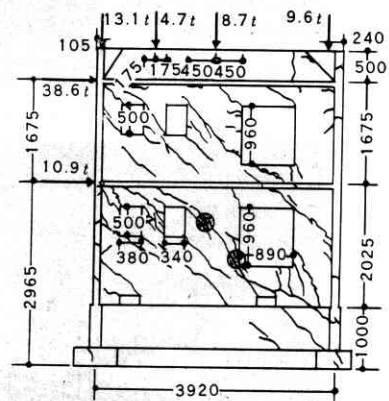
b A 構面ひび割れおよび破壊時の加力 (寸法 mm) 注: ○印の部分がせん断破壊を起こした
